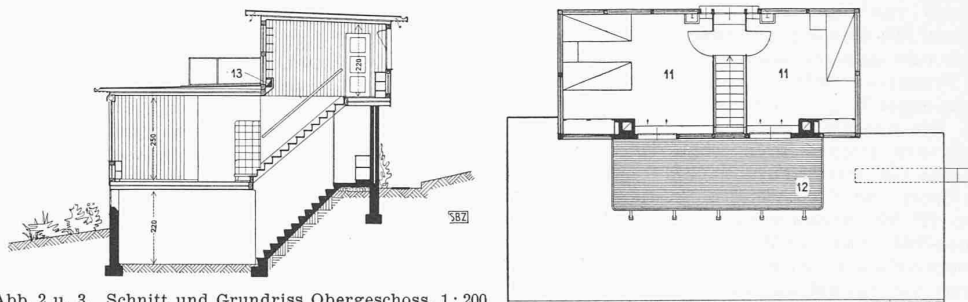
u. 3. Schnitt und Grundriss Obergeschoss, 1:200
